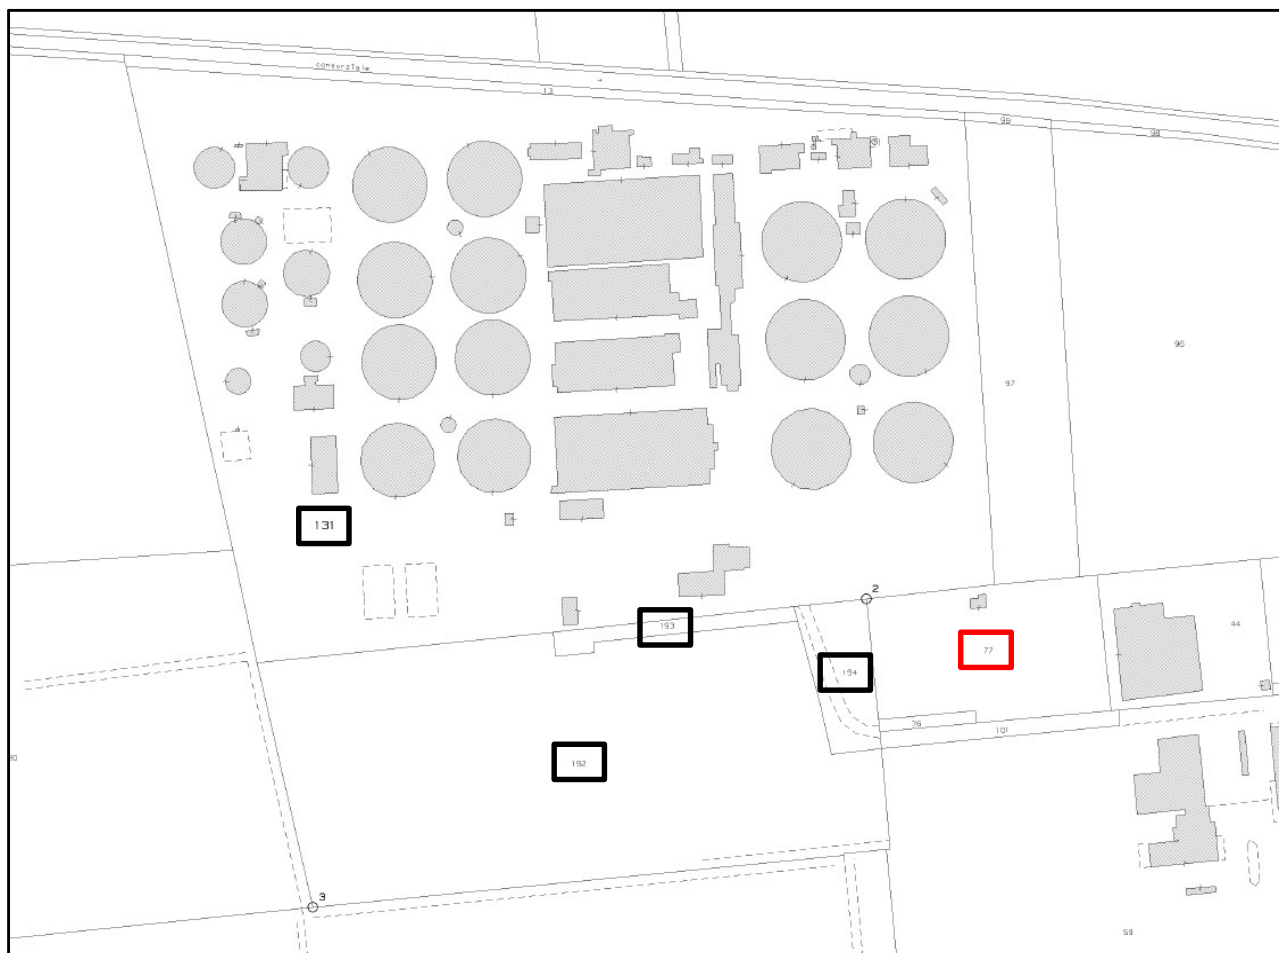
Planimetria catastale del depuratore e delle aree oggetto degli interventi di ampliamento
